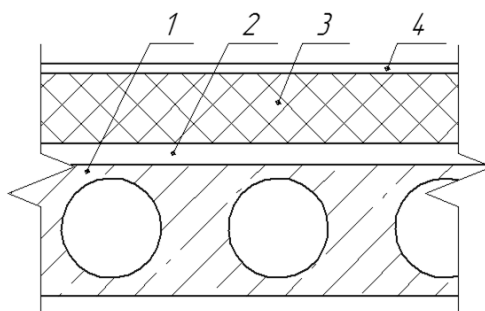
Эскиз чердачного перекрытия: 1 – ж/б пустотная плита;
